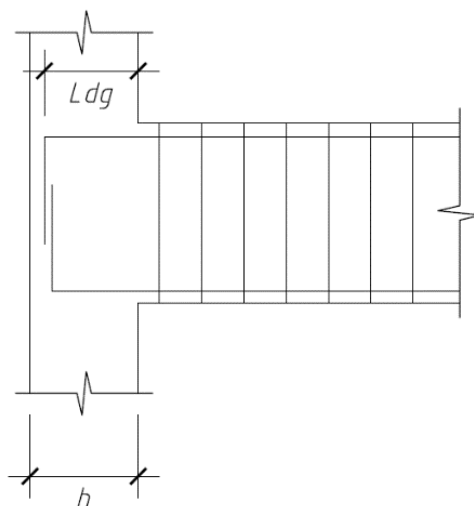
Longitud de anclaje en gancho estándar para vigas apoyadas en elementos verticales.
